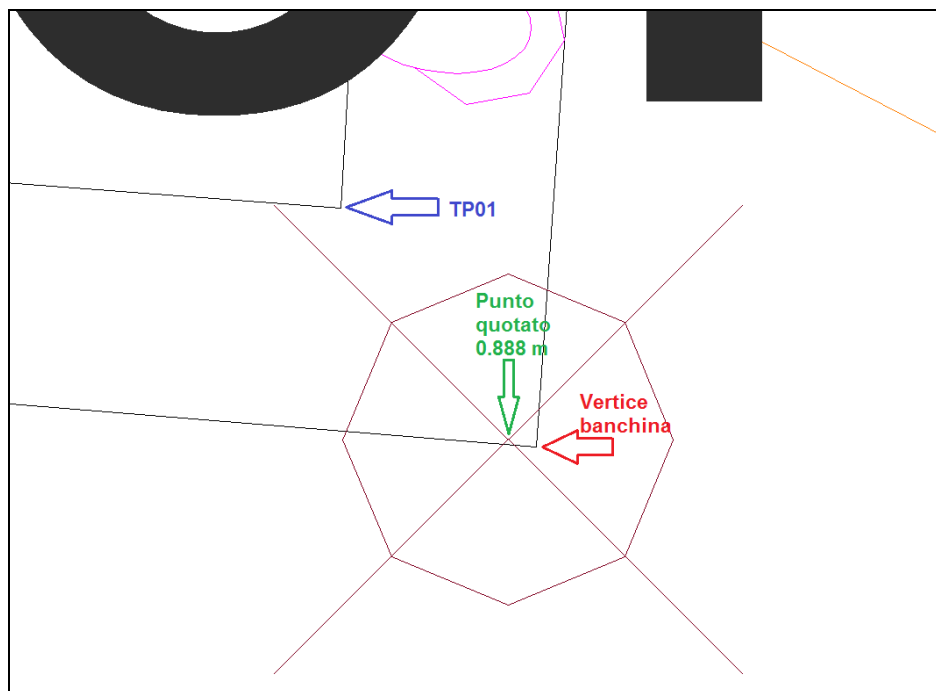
Immagine ricavata dalla planimetria fornita dalla Committenza (North Up). In rosso, il vertice orientale della testata della Banchina Orientale. In verde, il punto quotato riportato sulla planimetria. In blu, individuazione planimetrica del punto di riferimento per la verifica del sistema di posizionamento, denominato TP01.
